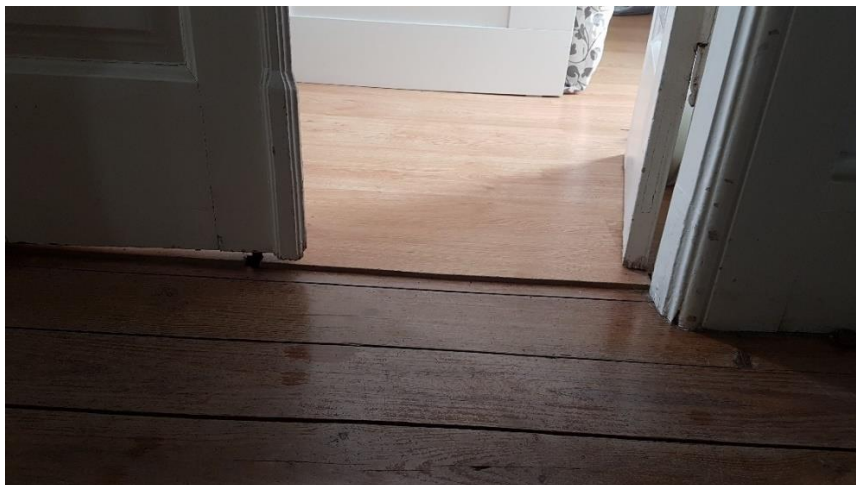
Transição do Pavimento em Madeira para o Pavimento Flutuante
